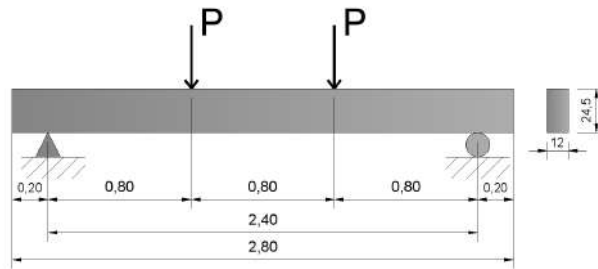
Viga tipo, modelada por Santos y col. (2014)
